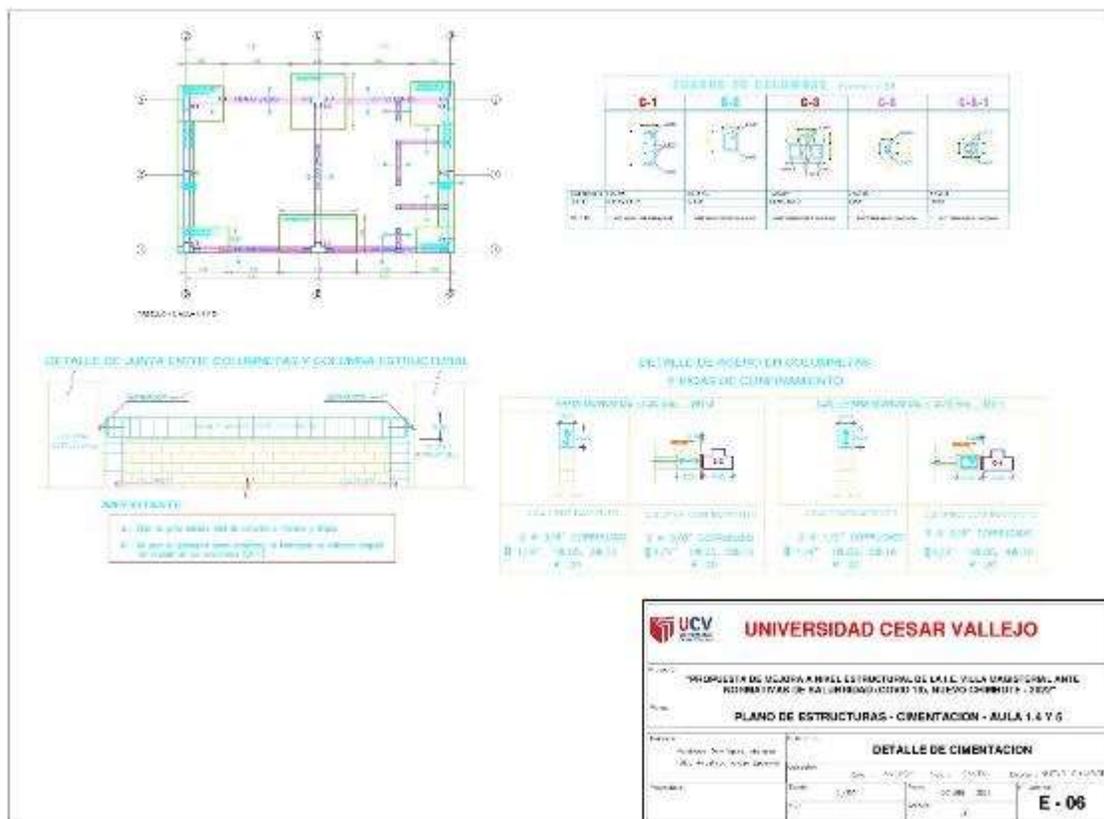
Plano de cimentación aulas 1,4,5 E-06
